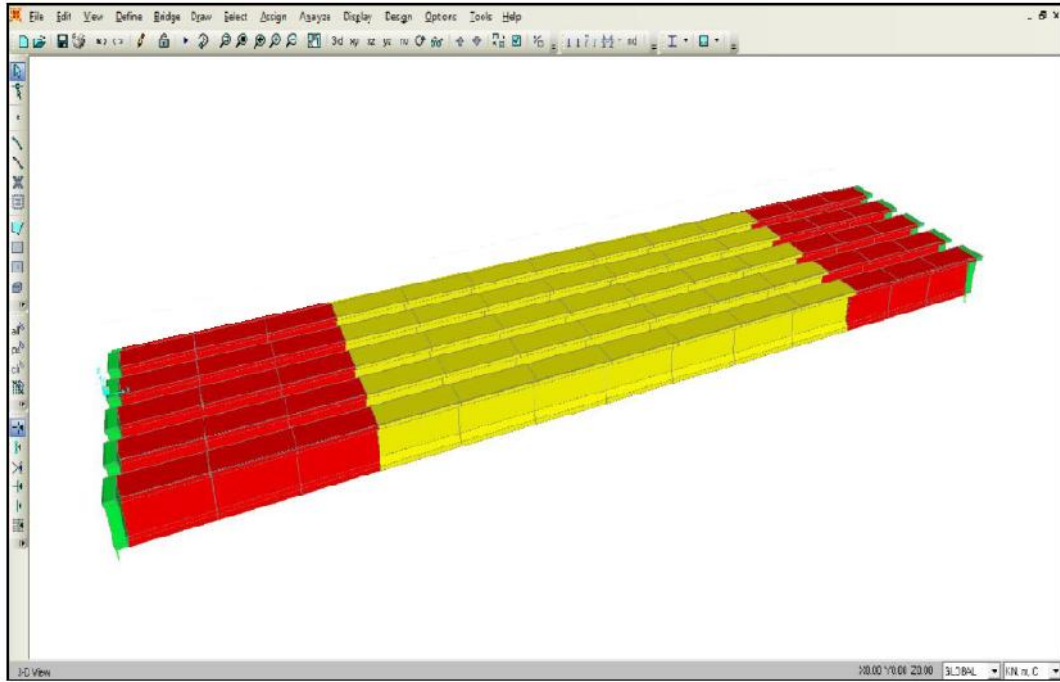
Modélisation des poutres avec leurs différentes sections
